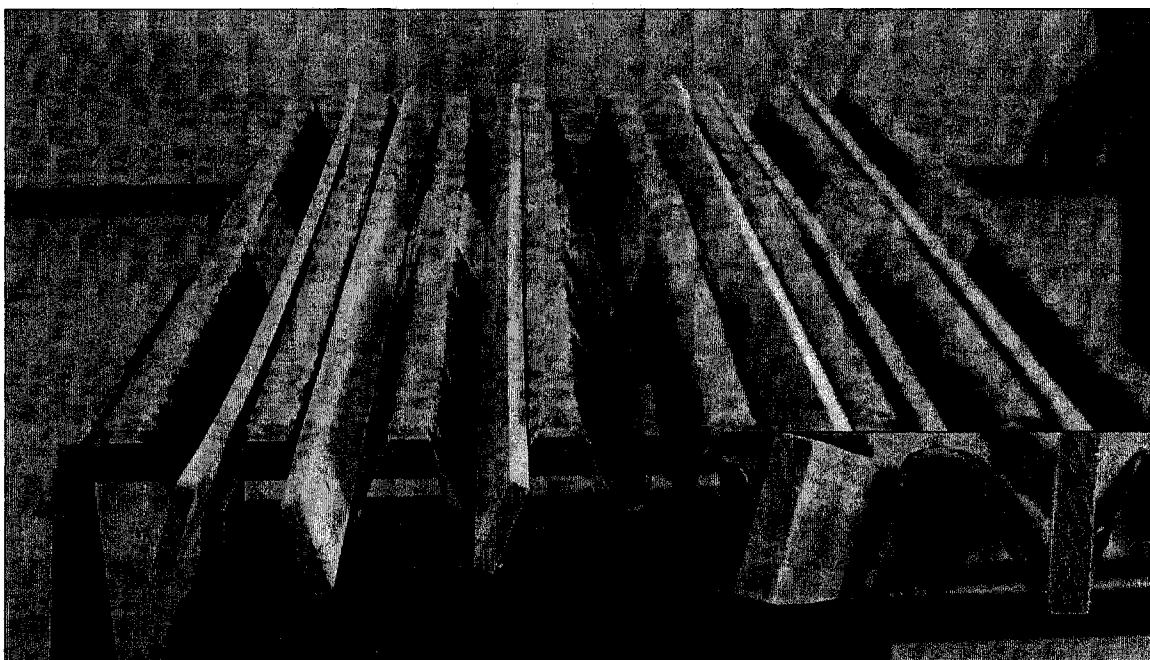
Panneaux profilés avec les surfaces de joint enduites d'adhésif et des planches de bois pour retenir les boulons lors de l'étape suivante.
